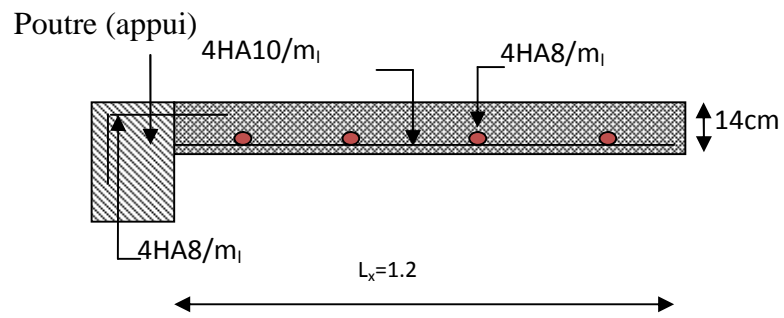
Schéma de ferrailage d'une dalle pleine sur un appui.
